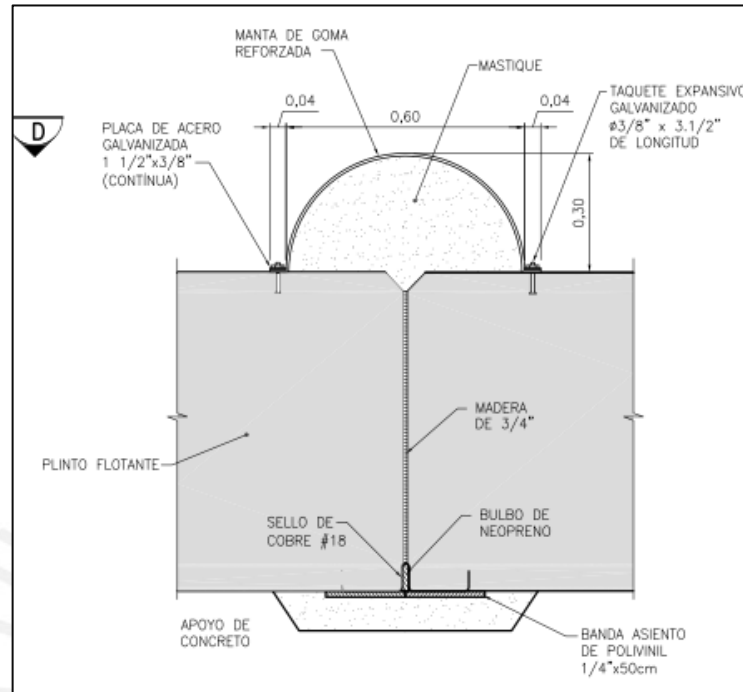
Detalles de Juntas en Plinto Flotante – Diseño Base (Intertechne 2010)
